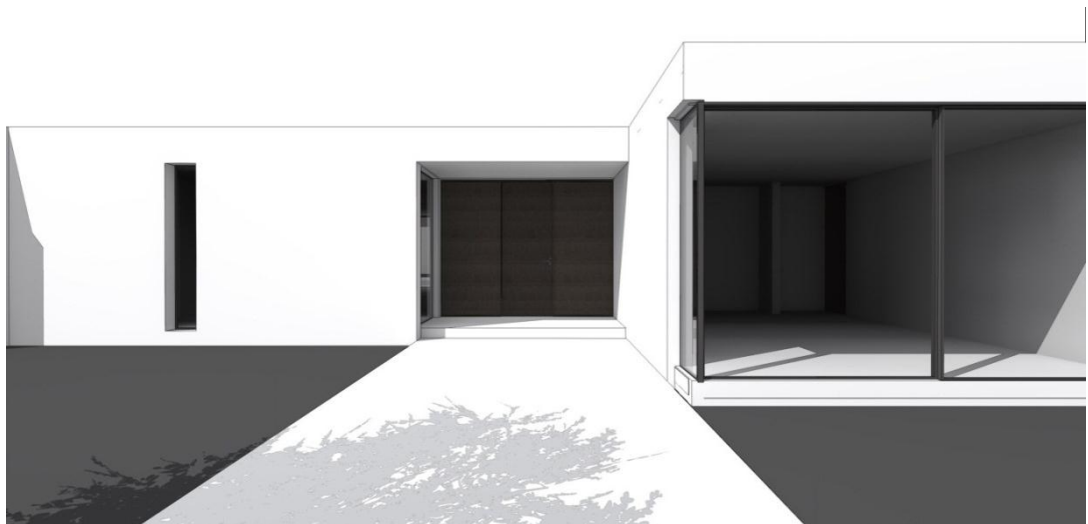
Vista 3d - acceso principal. Fuente: Elaboración propia.
